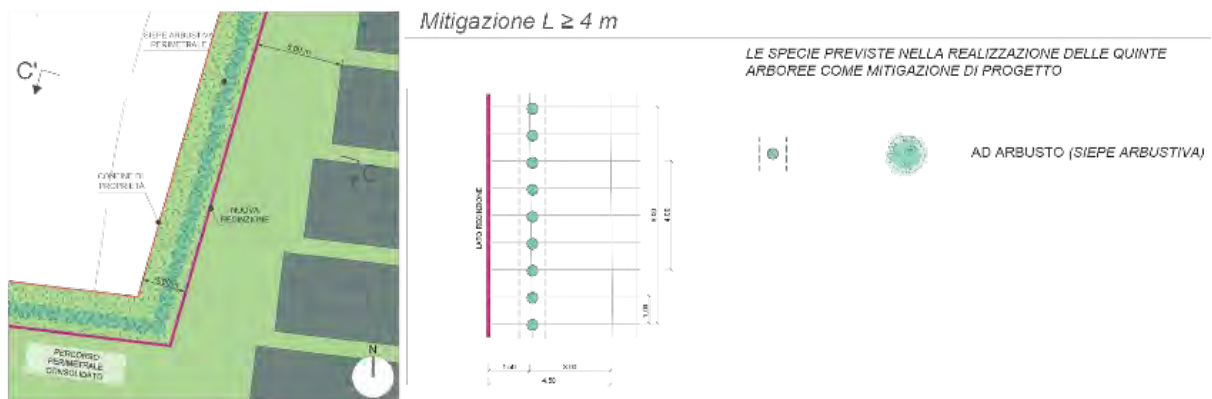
Dettaglio e rappresentazione schematica del sesto d'impianto della fascia di mitigazione di larghezza pari a 4 metri.
